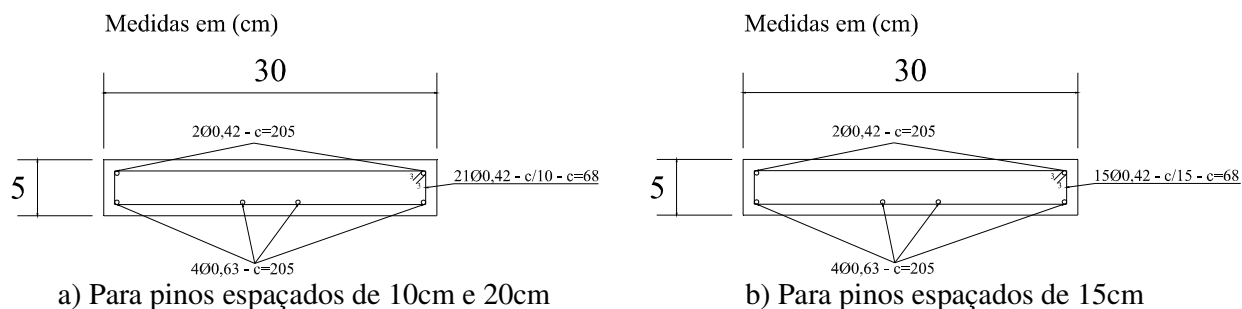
Armadura da mesa de concreto das vigas mistas
